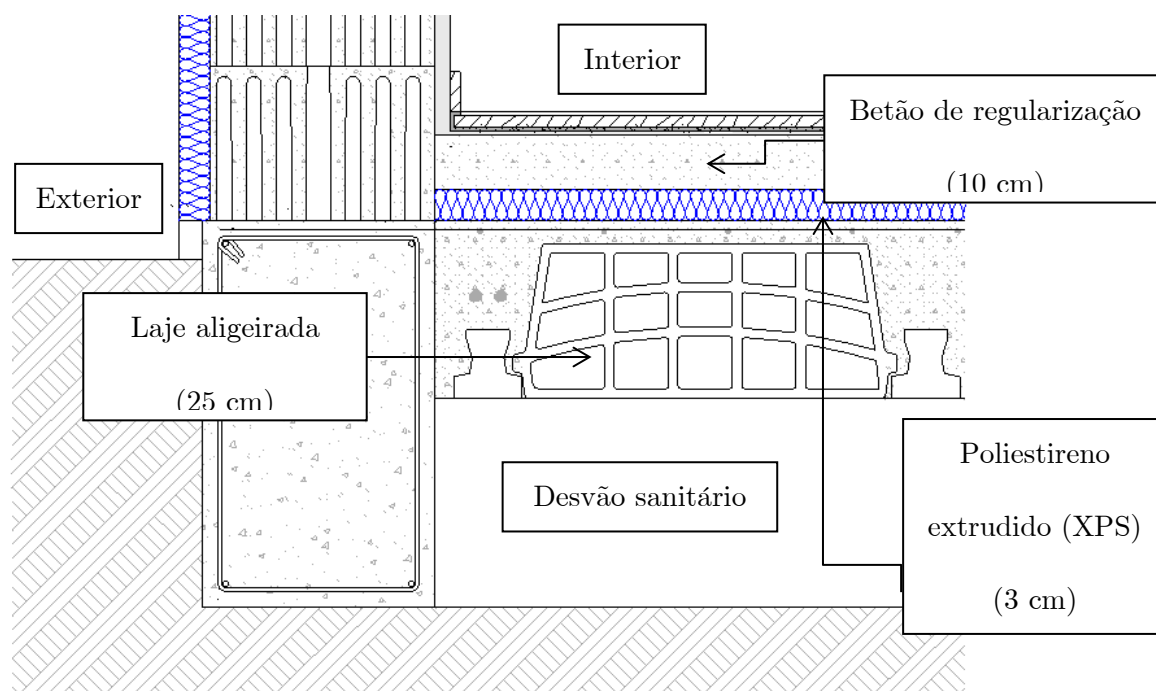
Pormenor construtivo do pavimento em contacto com o desvão sanitário
